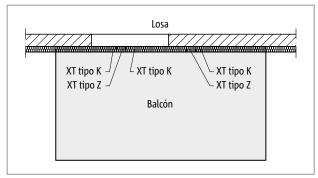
Schöck Isokorb® XT tipo Z, K: Balcón en voladizo
